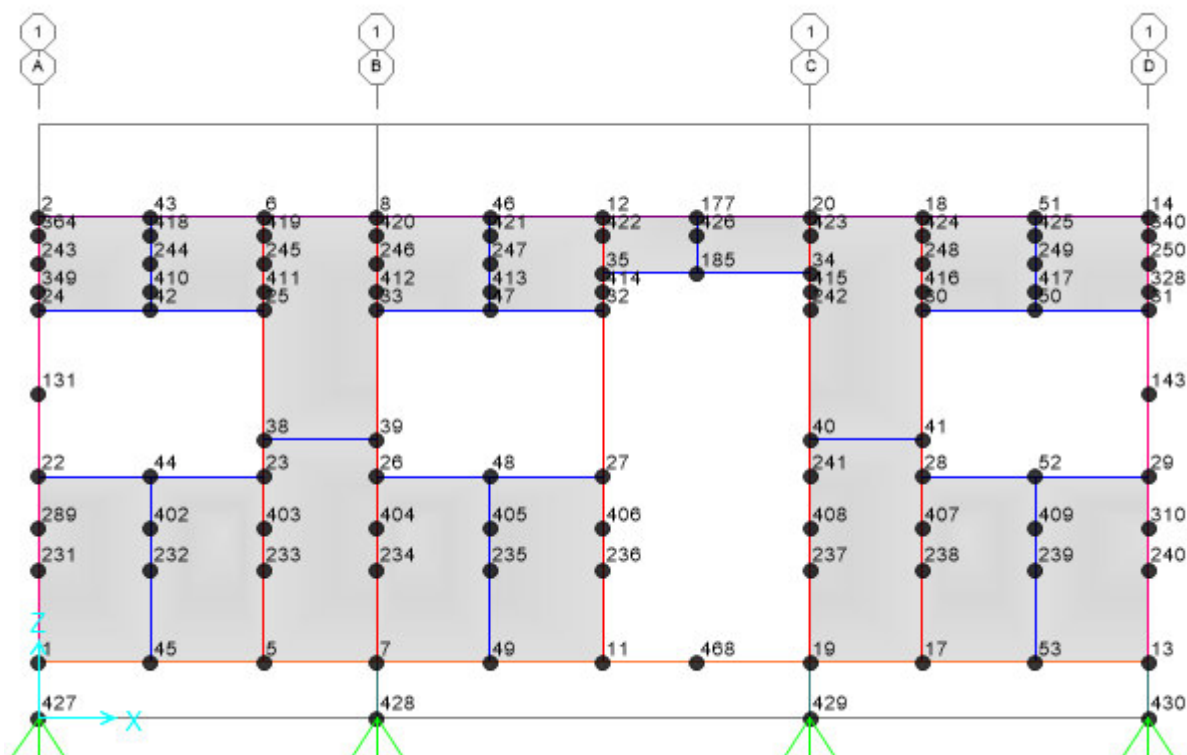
Etiquetas de Puntos - Eje 1 (Muro de Fachada): Alternativa 02
